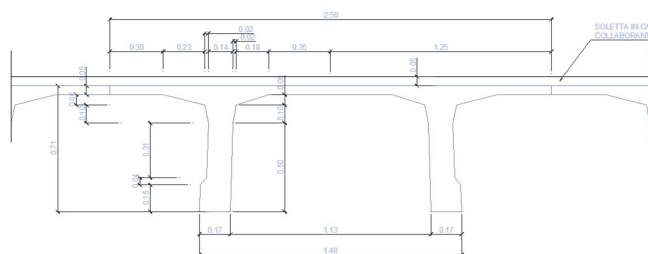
SEZIONE TIPO SOLAIO DI COPERTURA
